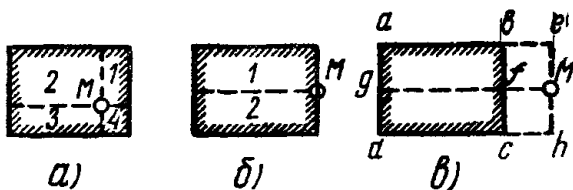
Схема разбивки подошвы фундамента на прямоугольники при определении осадок по методу угловых точек
